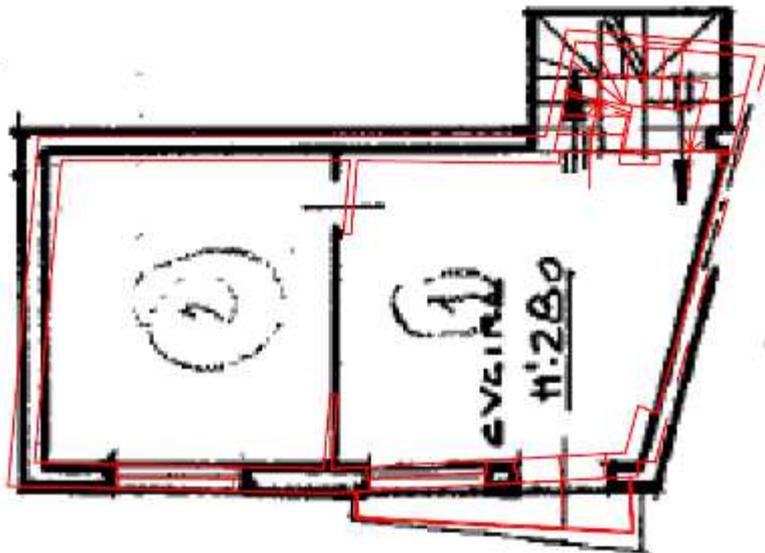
Sovrapposizione tra lo stato attuale - planimetria catastale, sub. 1 (p.1).
